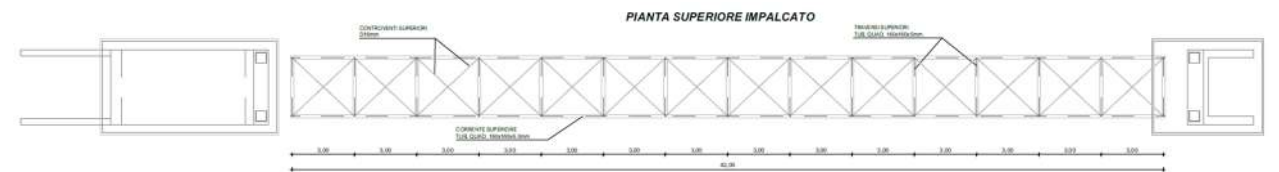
Passerella ciclopedonale – Pianta strutturale superiore
